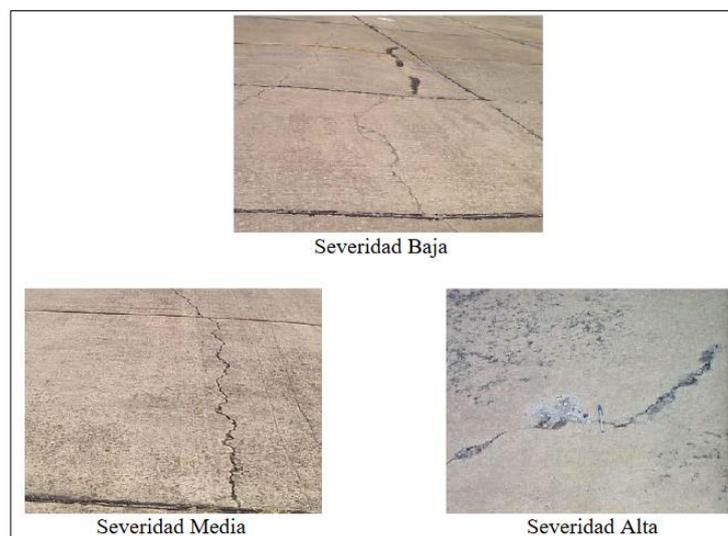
Fisuras Longitudinales, Transversales y Diagonales [9].
